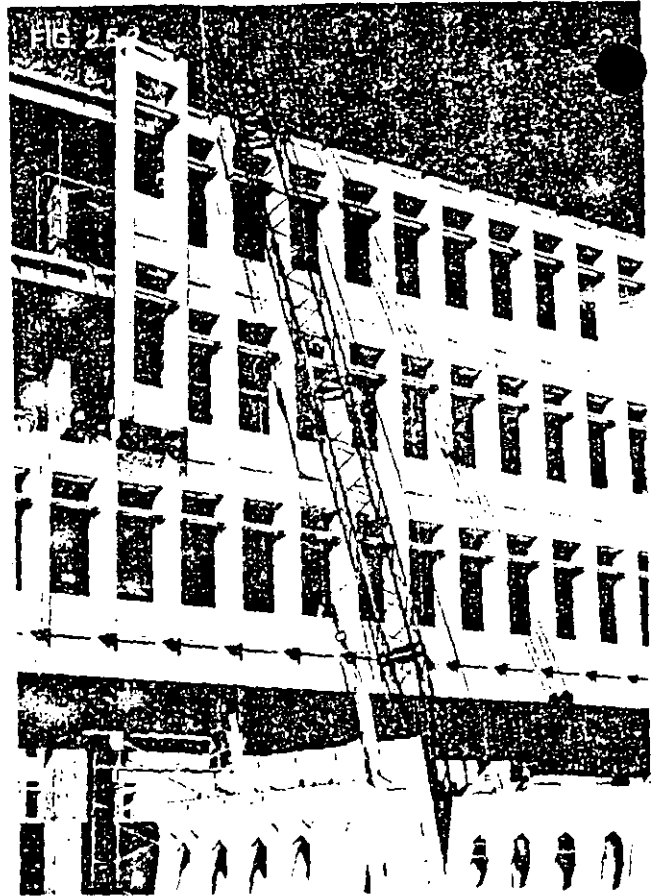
PANELES AUTOPORTANTE DE MUROS
